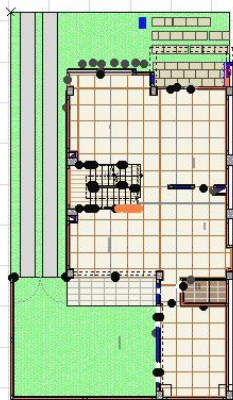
Planta 1. Tomado de Fénix Construcciones.
